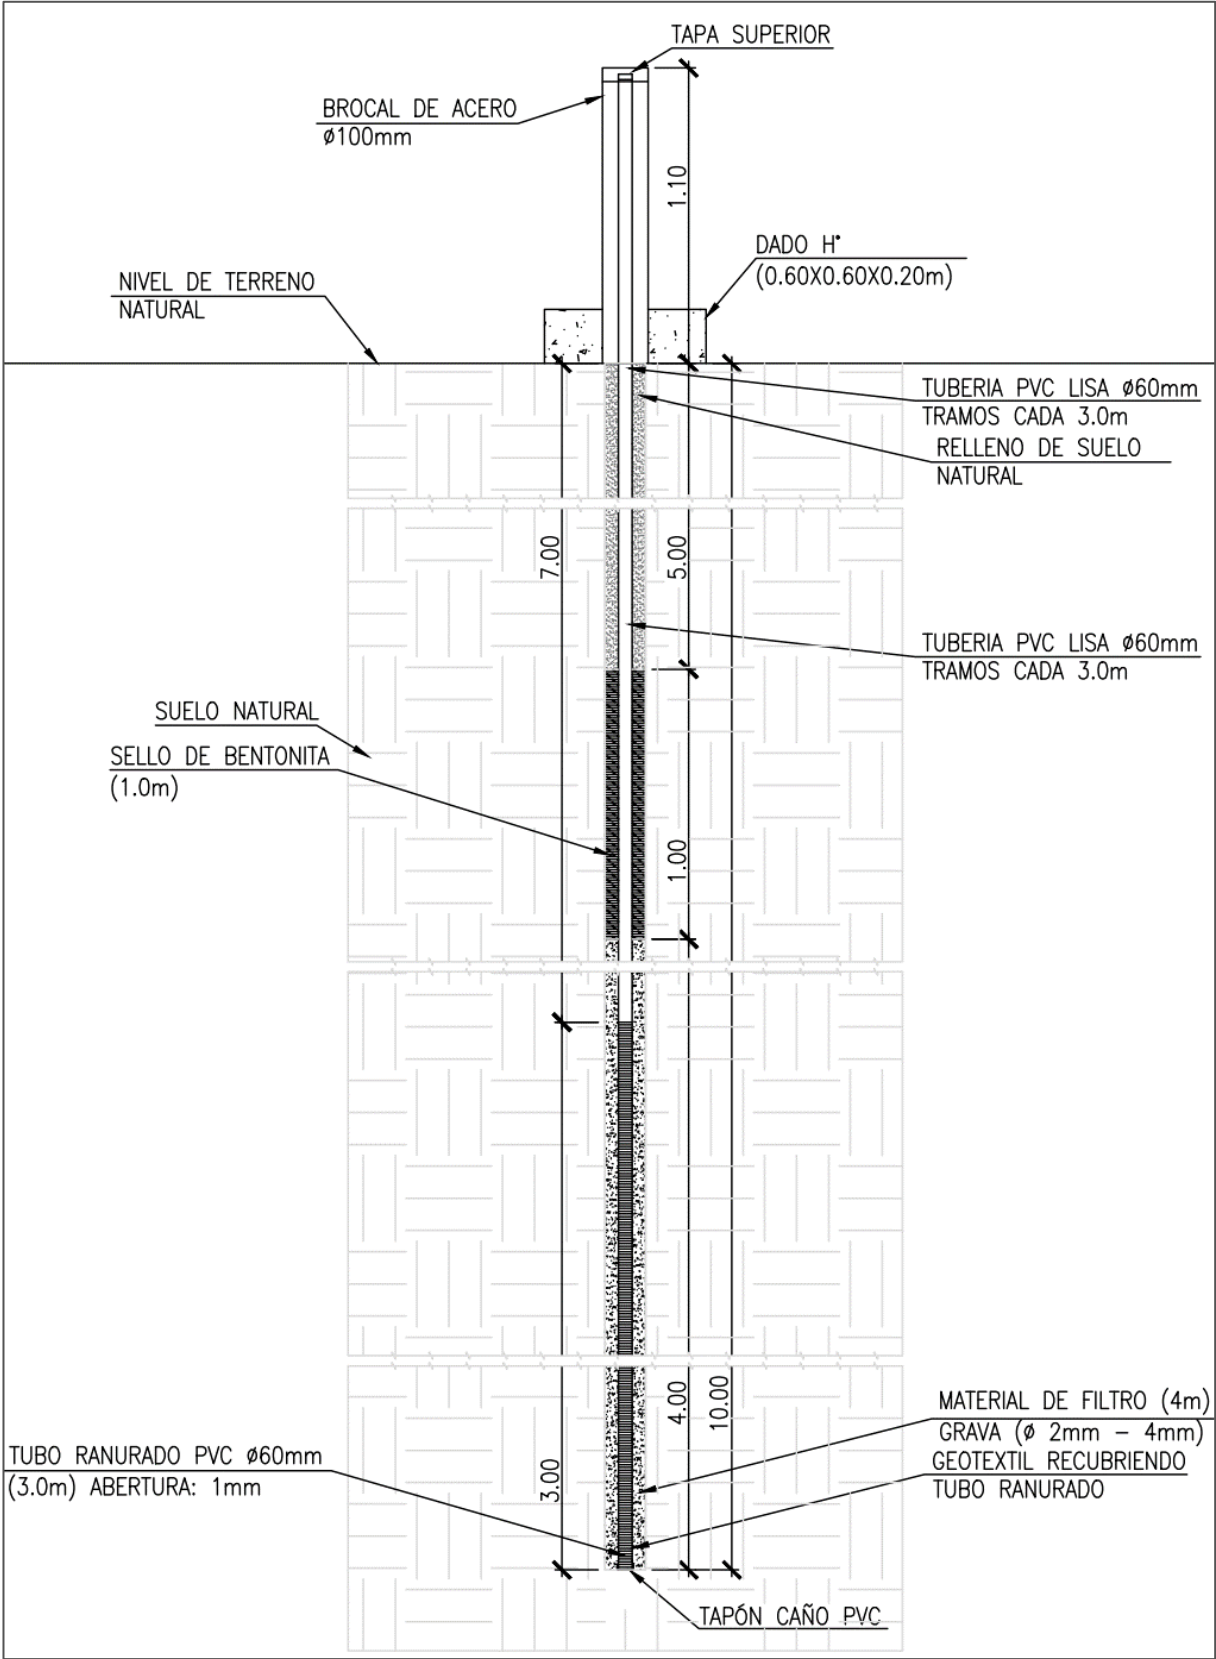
Esquema en detalle del perfil SRK-2023-BH04
